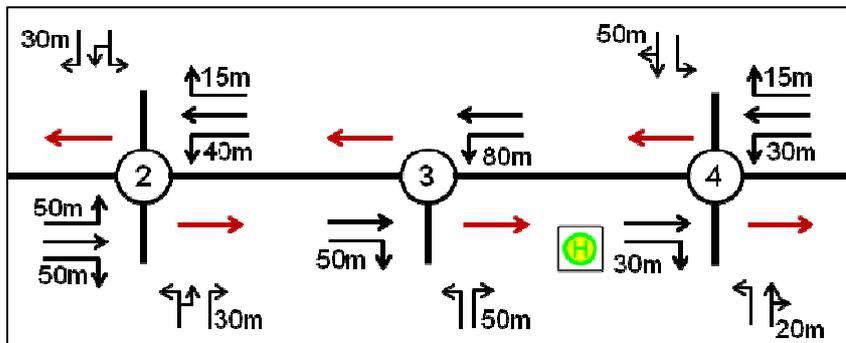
Verkehrstechnische Dimensionierung Variante 2x1
